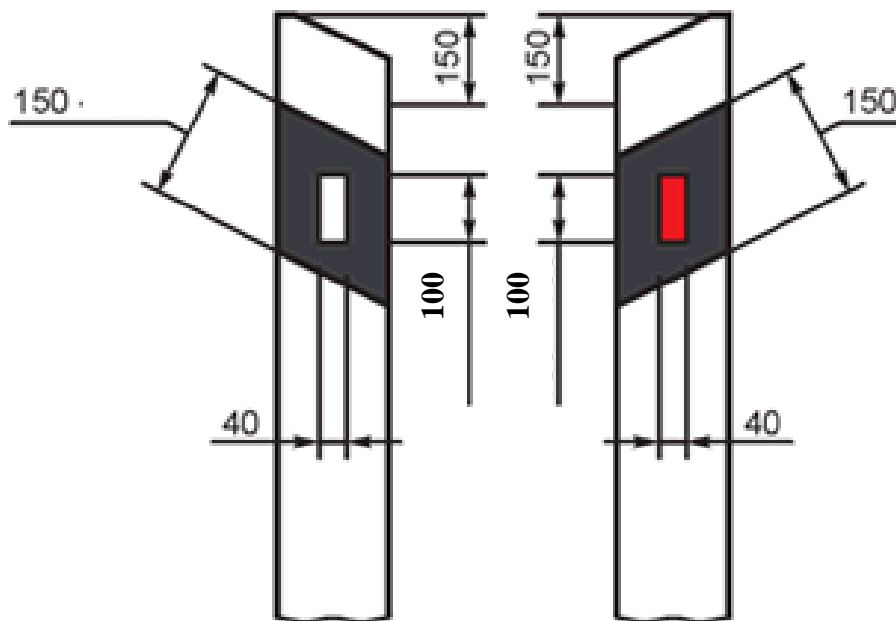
Вертикальная разметка сигнальных столбиков, имеющих скос в верхней части корпуса
